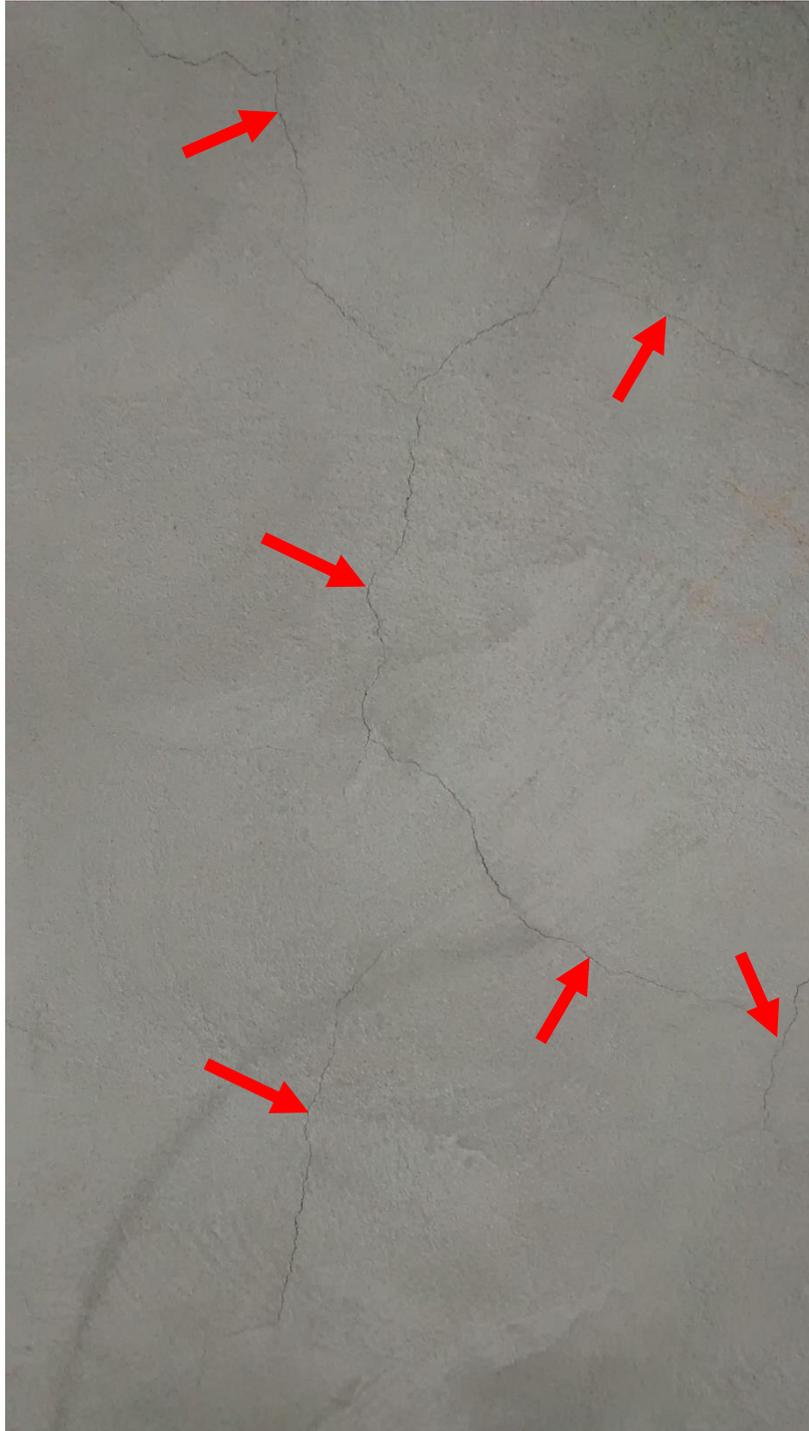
Fissuras na alvenaria dos sanitários e estar. (Fonte: Dos autores 2016)
